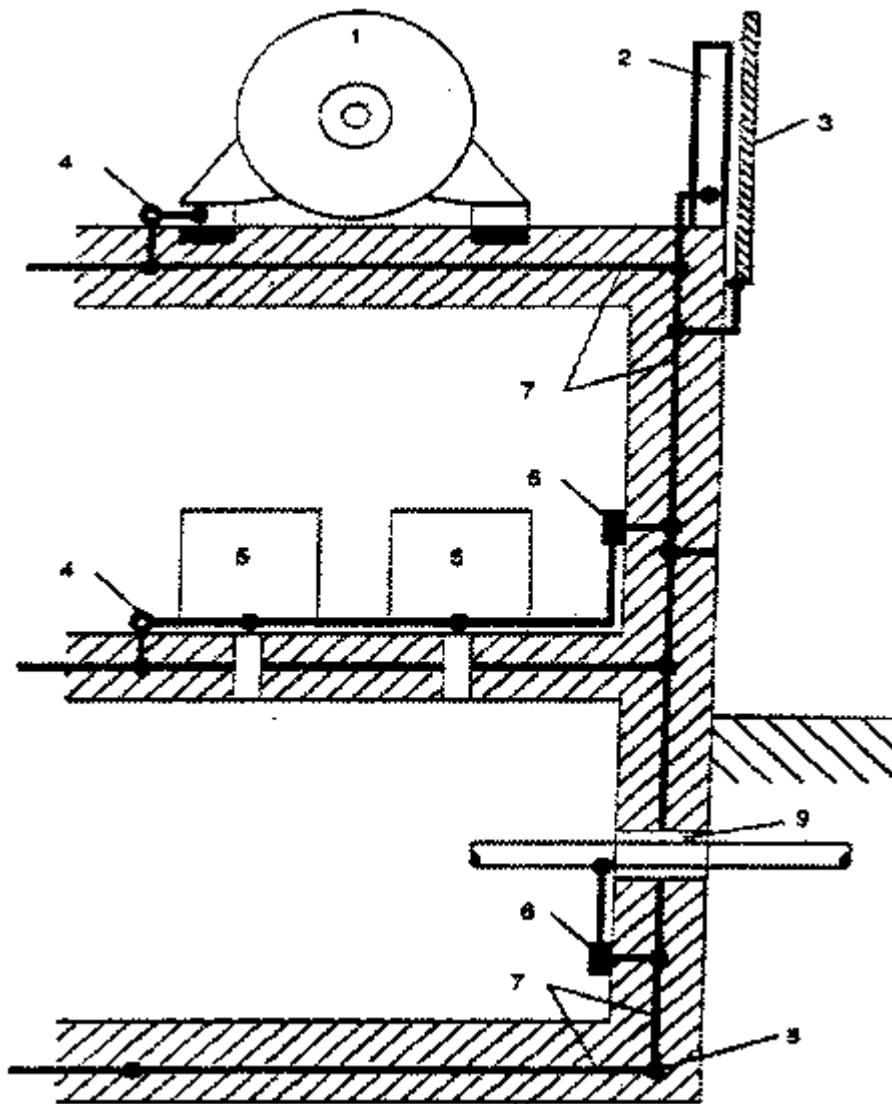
一钢筋混凝土建筑物内等电位连接的例子
